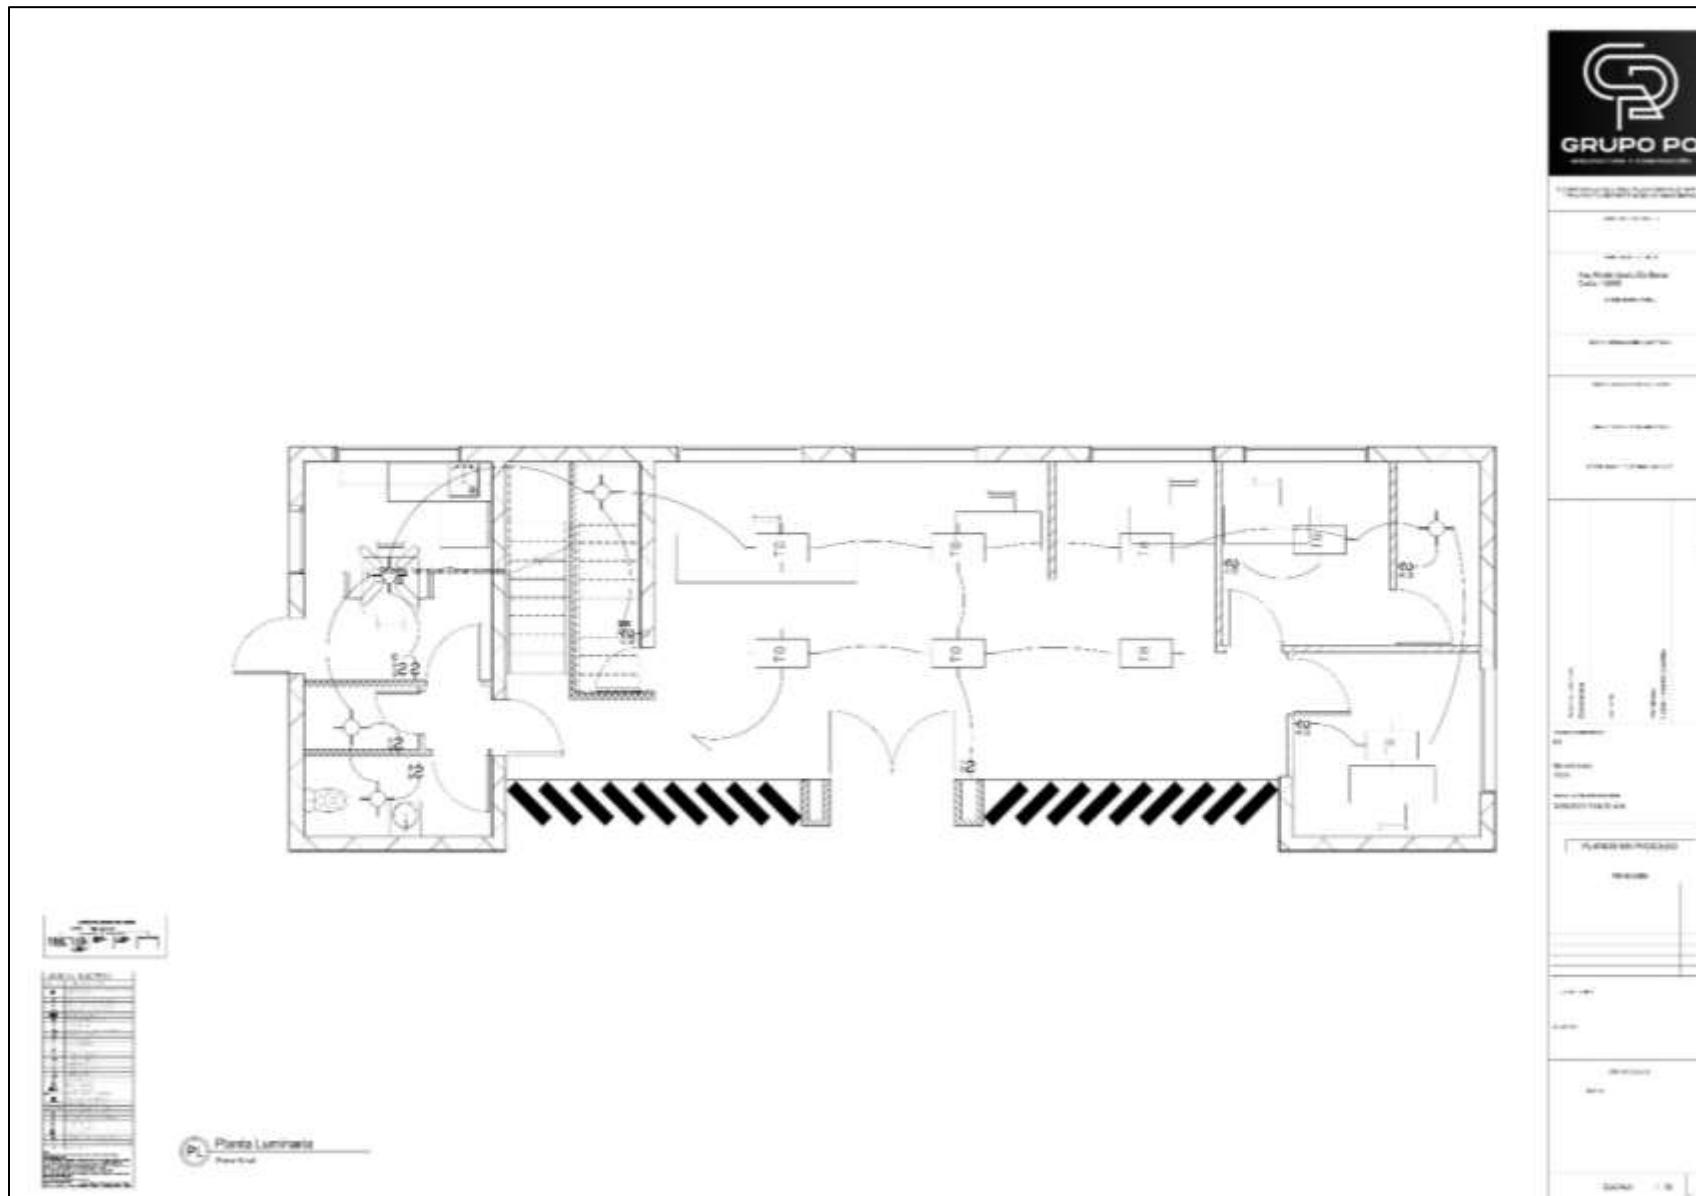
Plano de Planta Luminarias 1er Nivel
